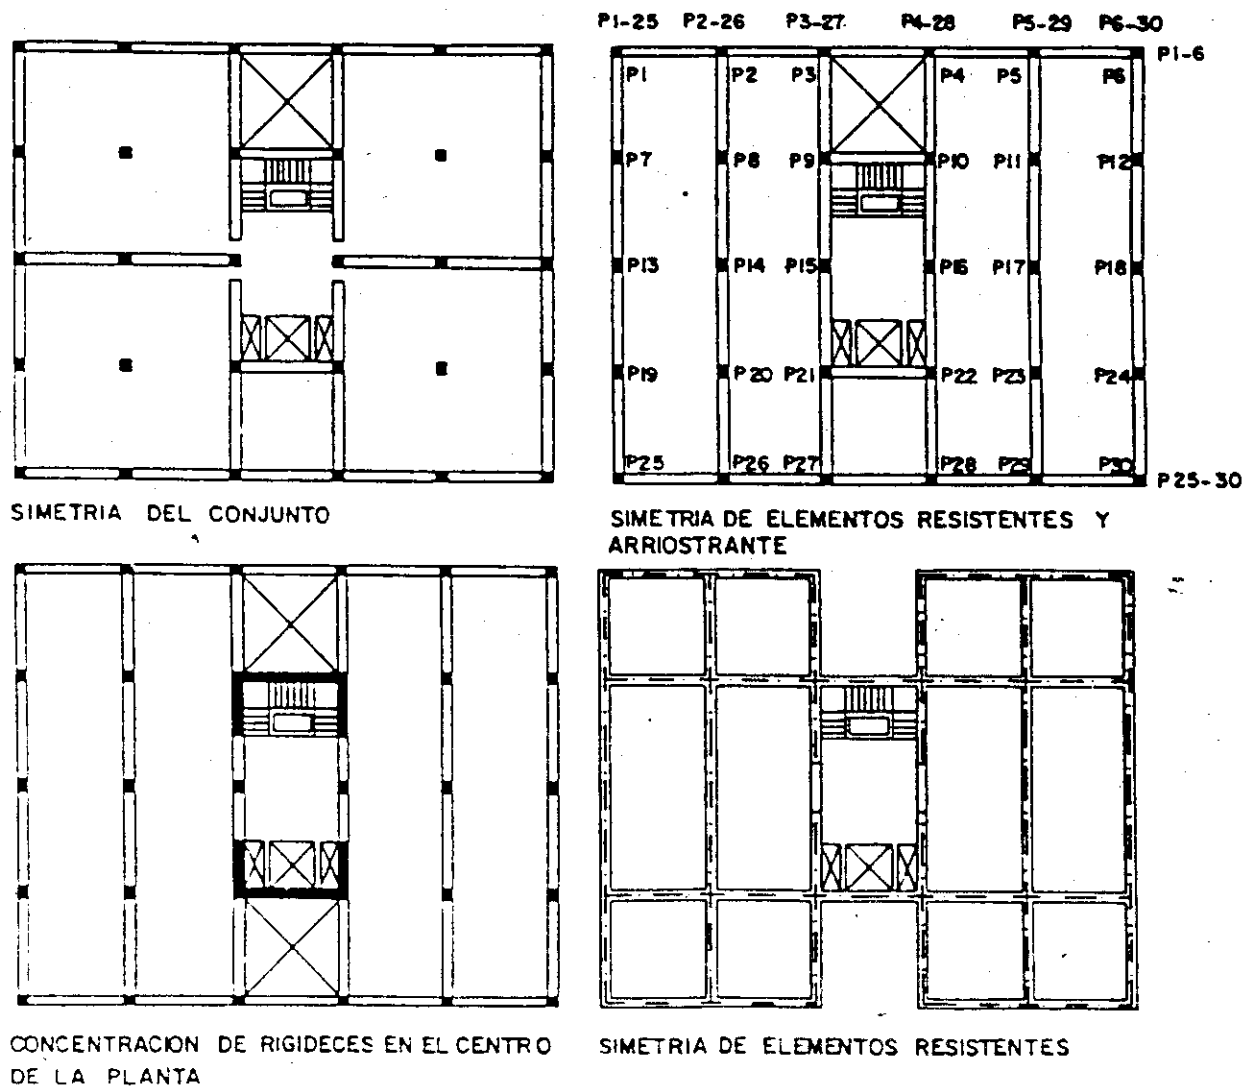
Disposiciones simétricas, geométrica y mecánica.
